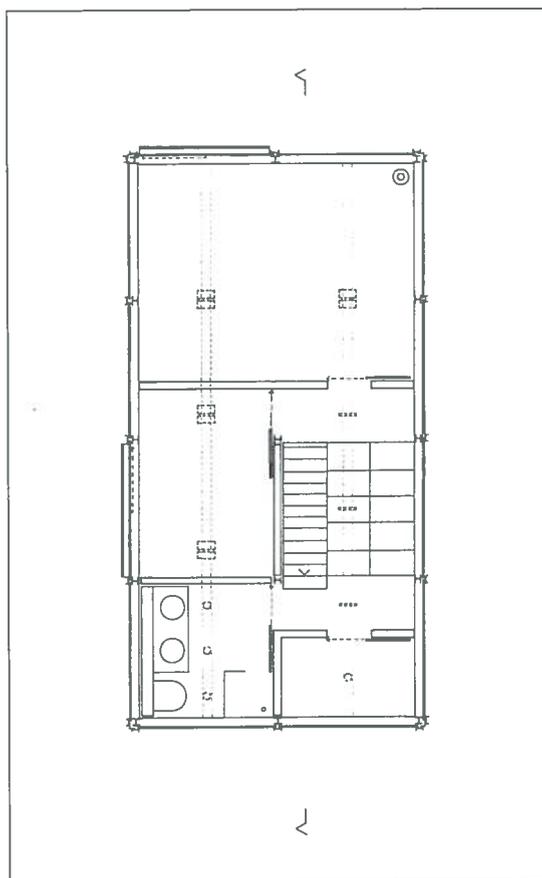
Pianta del secondo piano: all'ultimo piano si trovano le camere da letto, il bagno e una cabina armadio.
